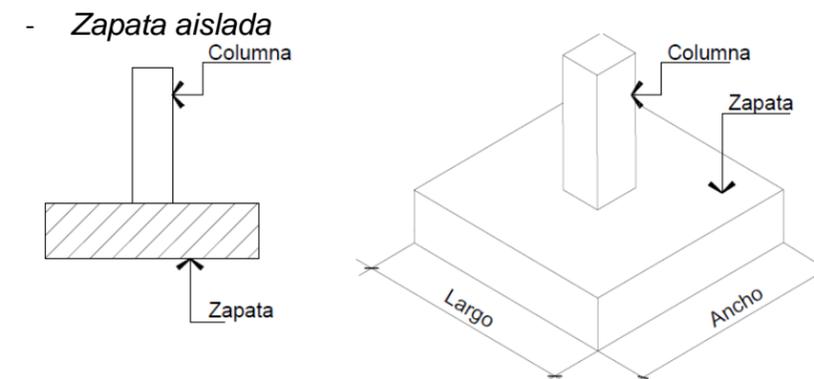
Detalle de zapata aislada. Fuente: equipo de trabajo
